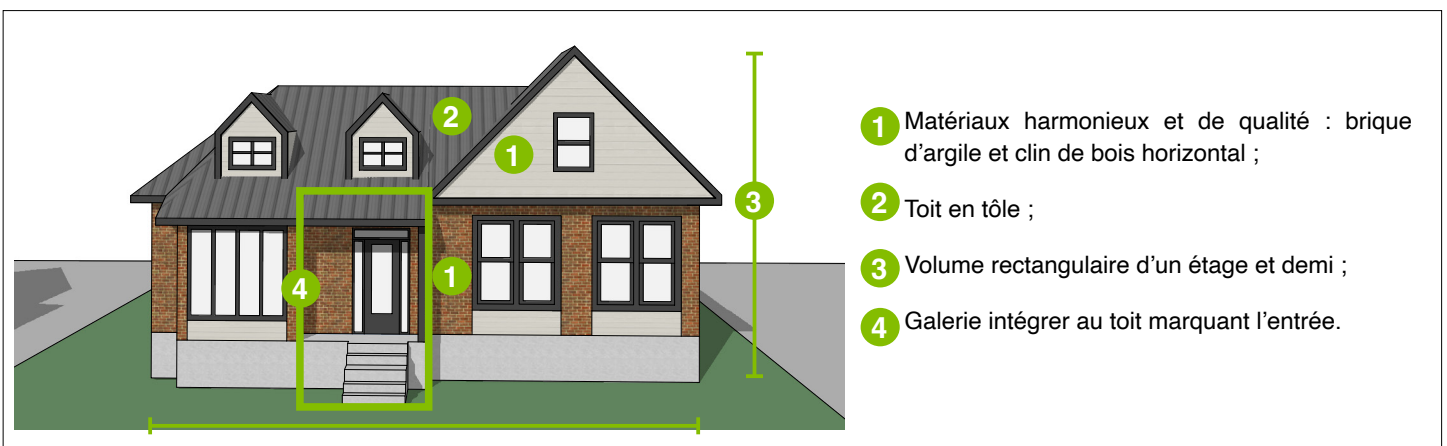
Bon exemple de traitement architectural d'une nouvelle construction
